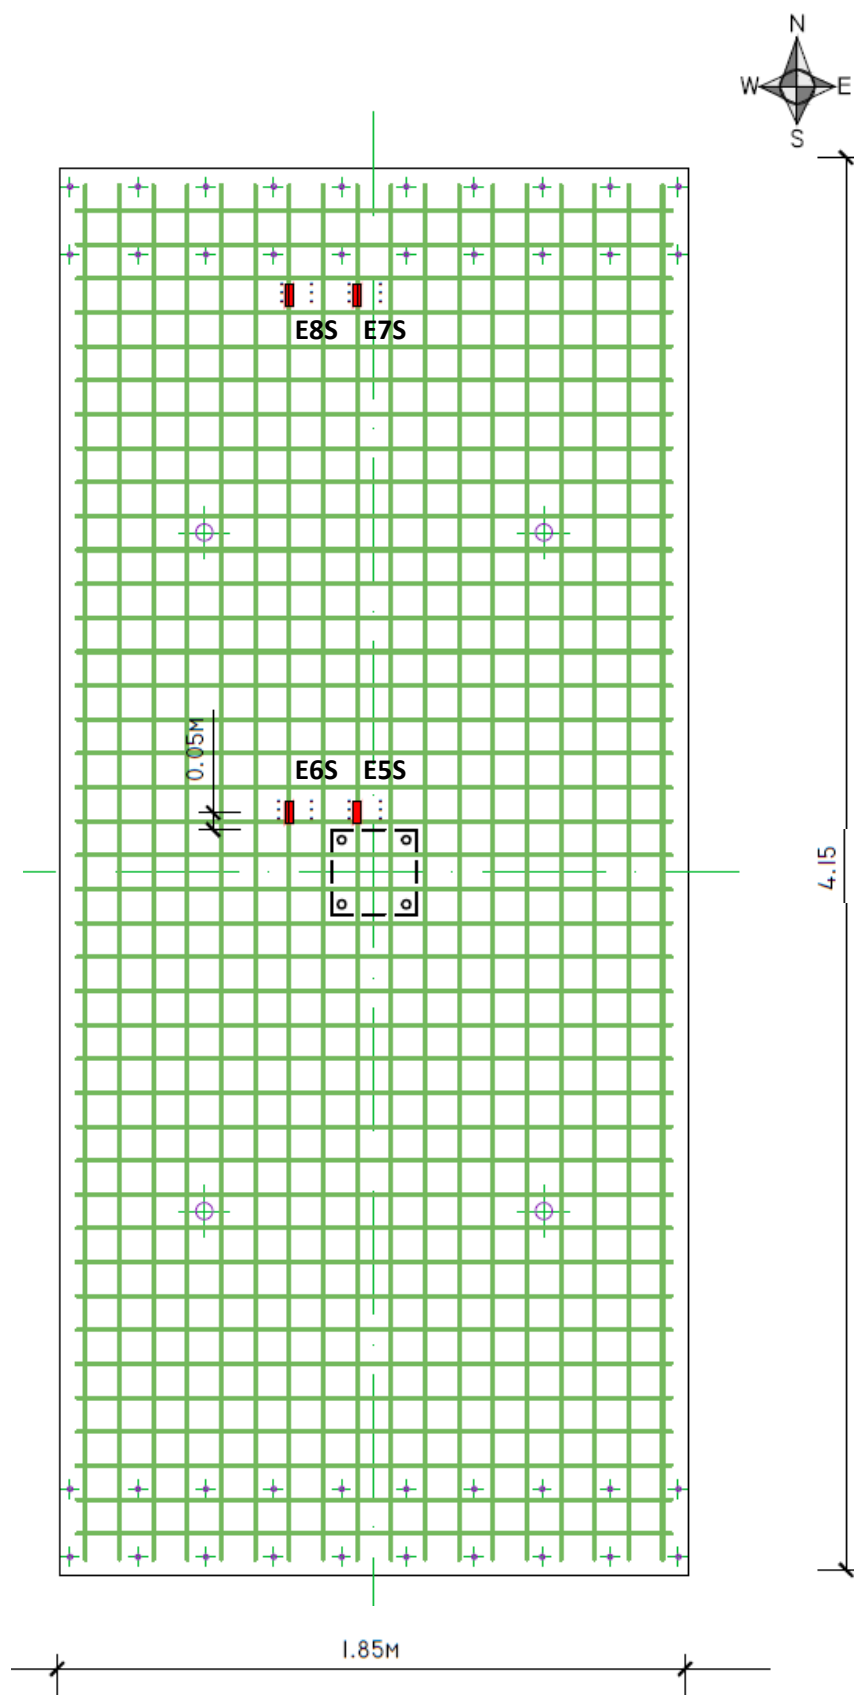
Localização dos extensómetros instalados na armadura longitudinal inferior.
